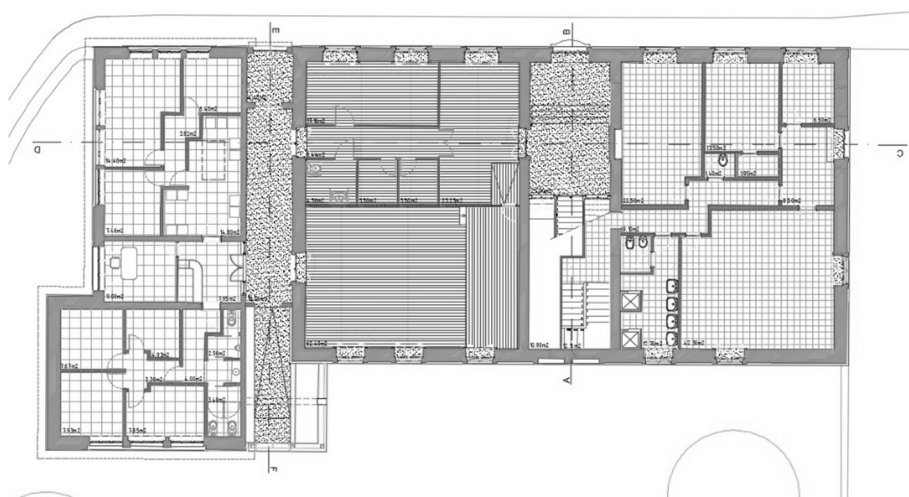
Planta do rés-do-chão (s/escala) – (Autor)
